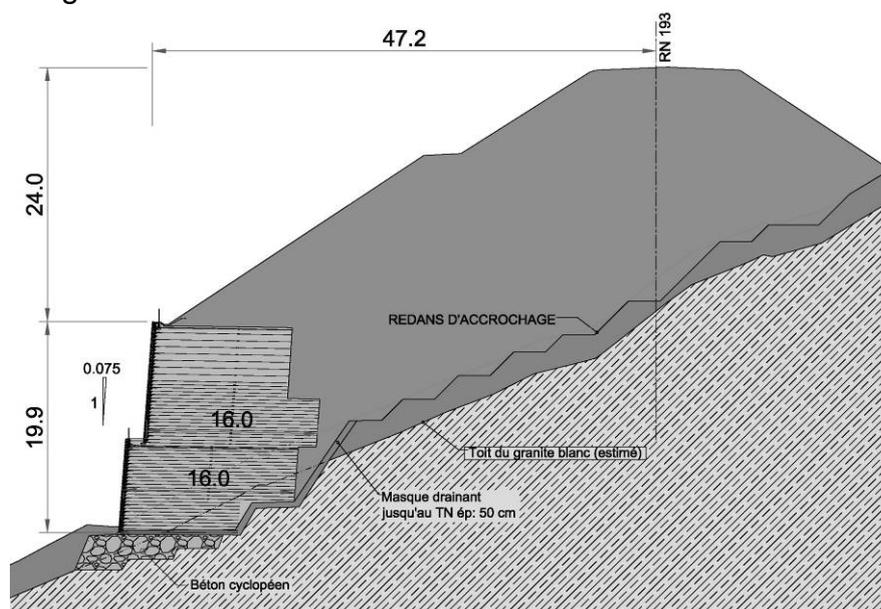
Coupe type dans l'axe de la section la plus haute du projet
